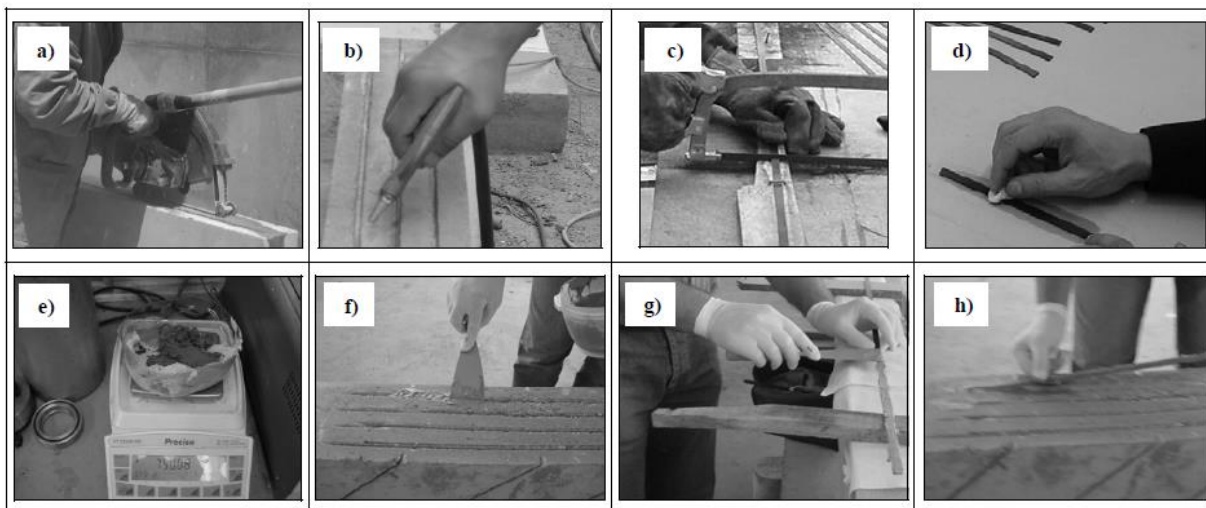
Execução do reforço à flexão de uma viga de betão armado com laminados de CFRP inseridos (Dias, 2008).
